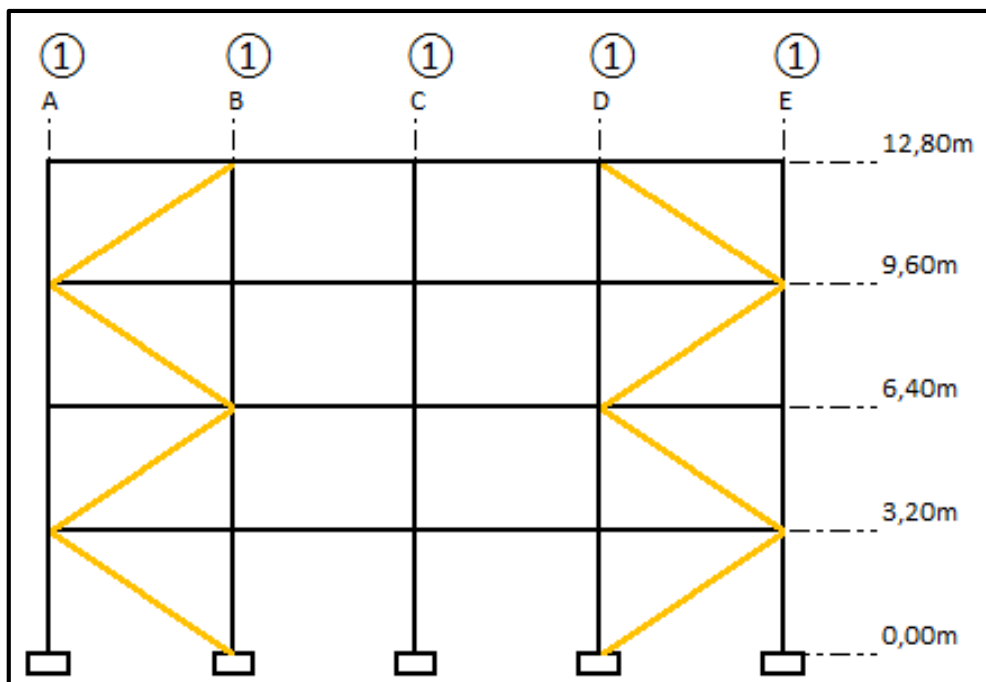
Fachada frontal y posterior, edificación con arriostramiento.
